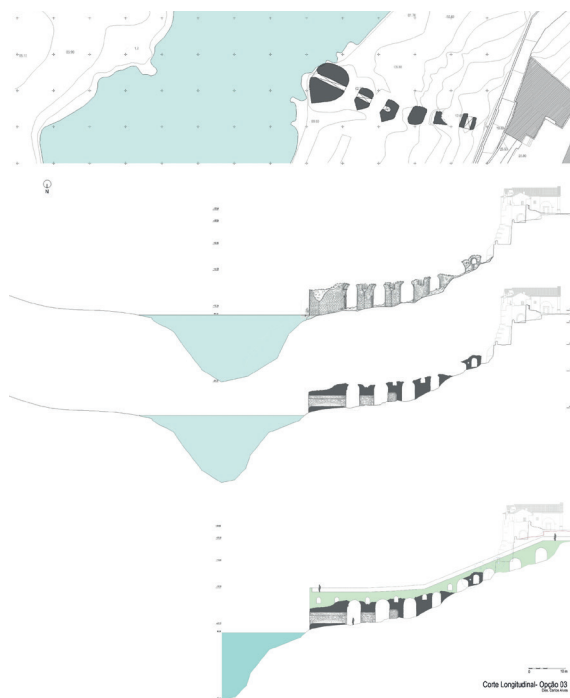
Torre do Rio, planta, alçados e proposta de reconstrução funcional (desenho de Carlos Alves)
